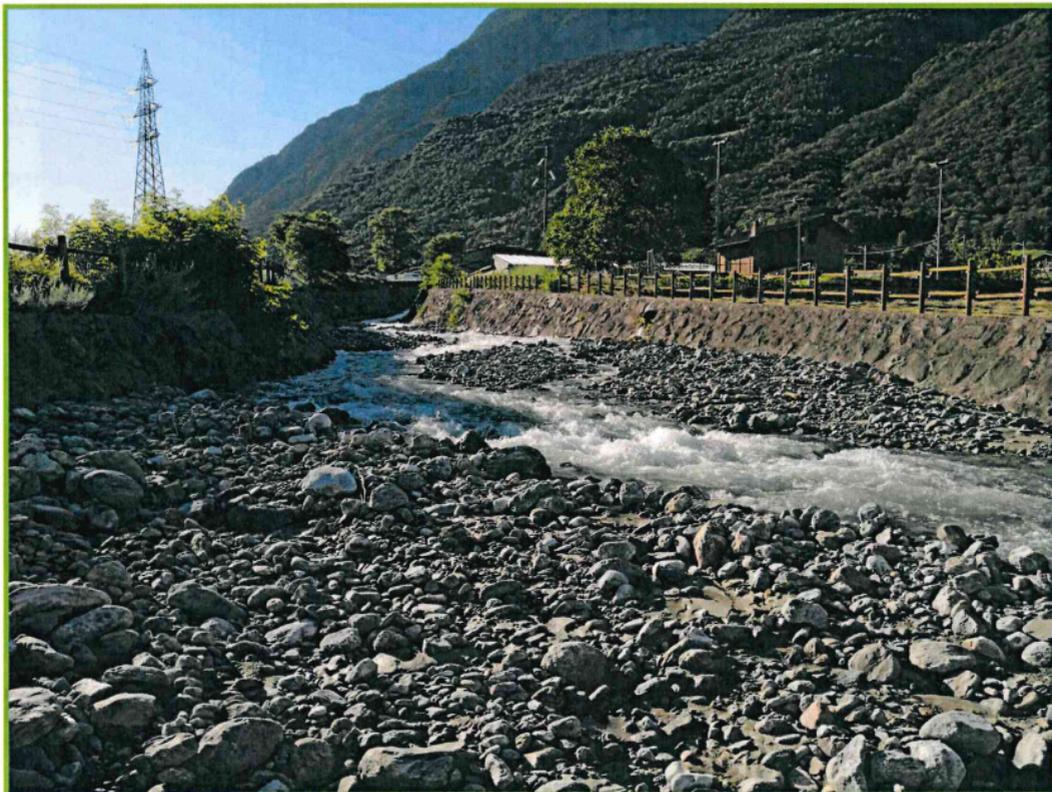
particolare della fondazione del muro di sponda SX sottoscavato
